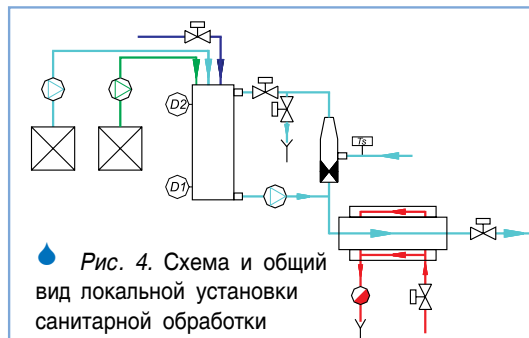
Схема и общий вид локальной установки санитарной обработки
